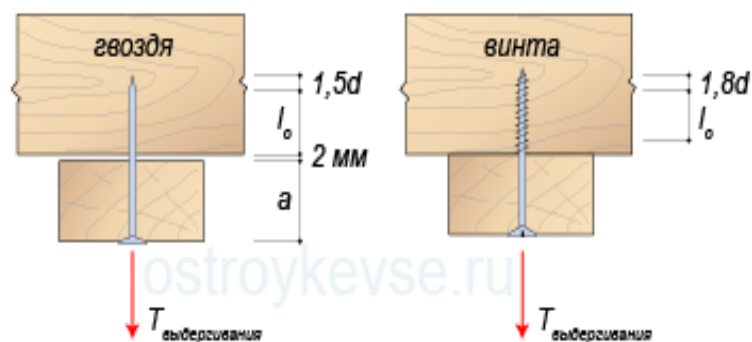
Определение расчетной рабочей длины стального нагеля, работающего на выдергивание
